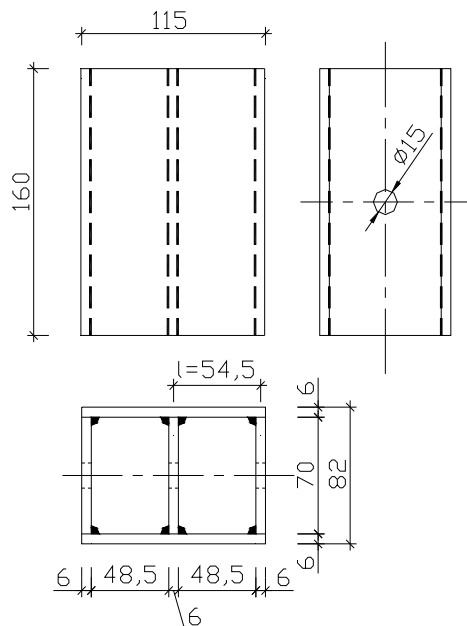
Сварной вкладыш конькового узла
